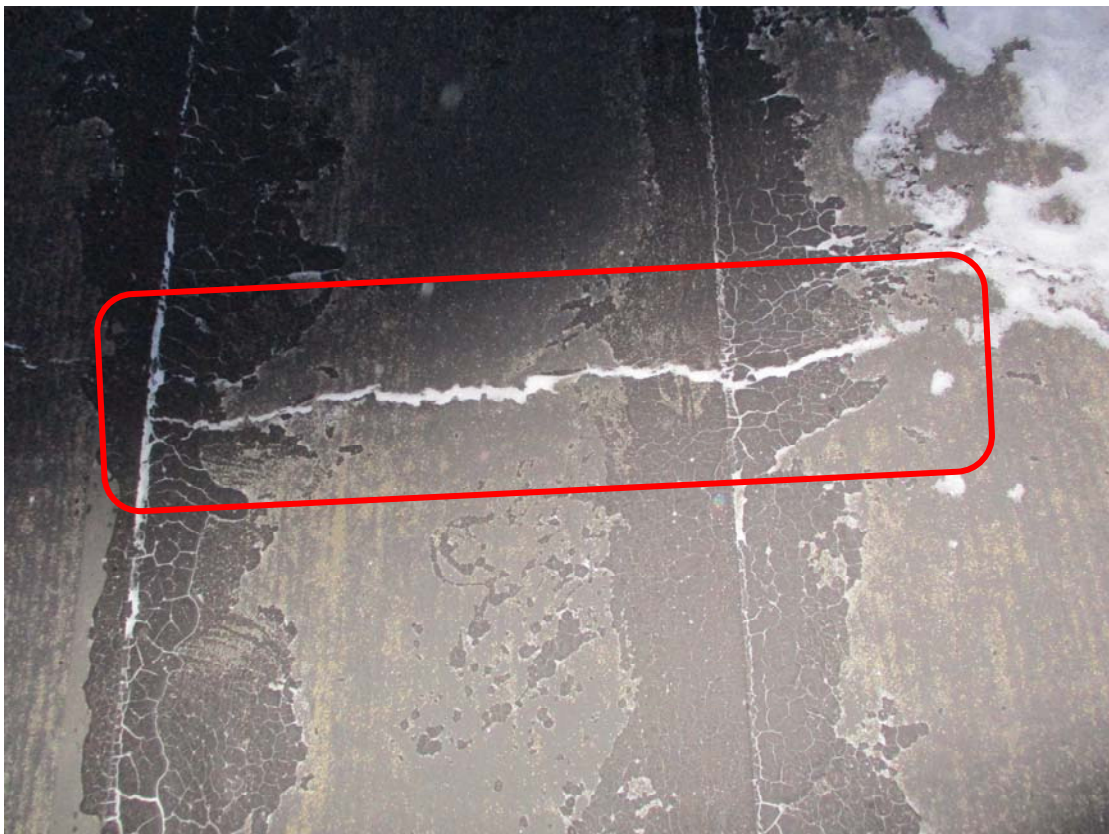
Трещины в гидроизоляционном покрытии.
